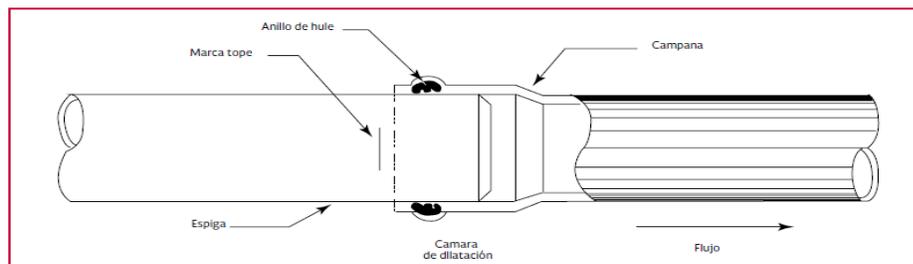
Union Espiga Campana en Tubería de PVC
